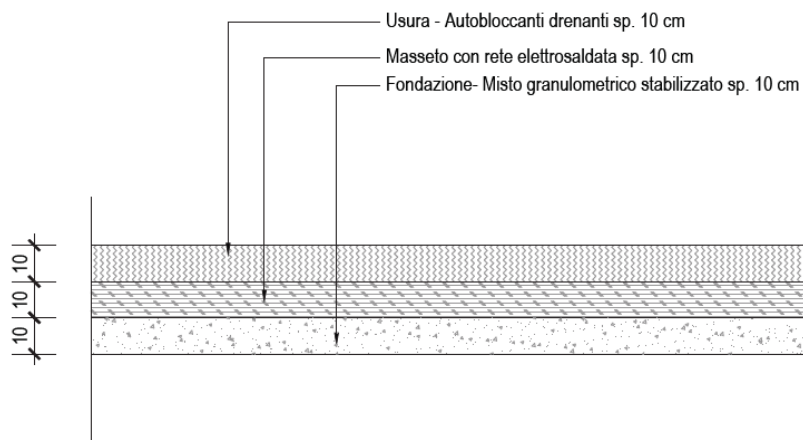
Pacchetto pavimentazione stalli parcheggio
